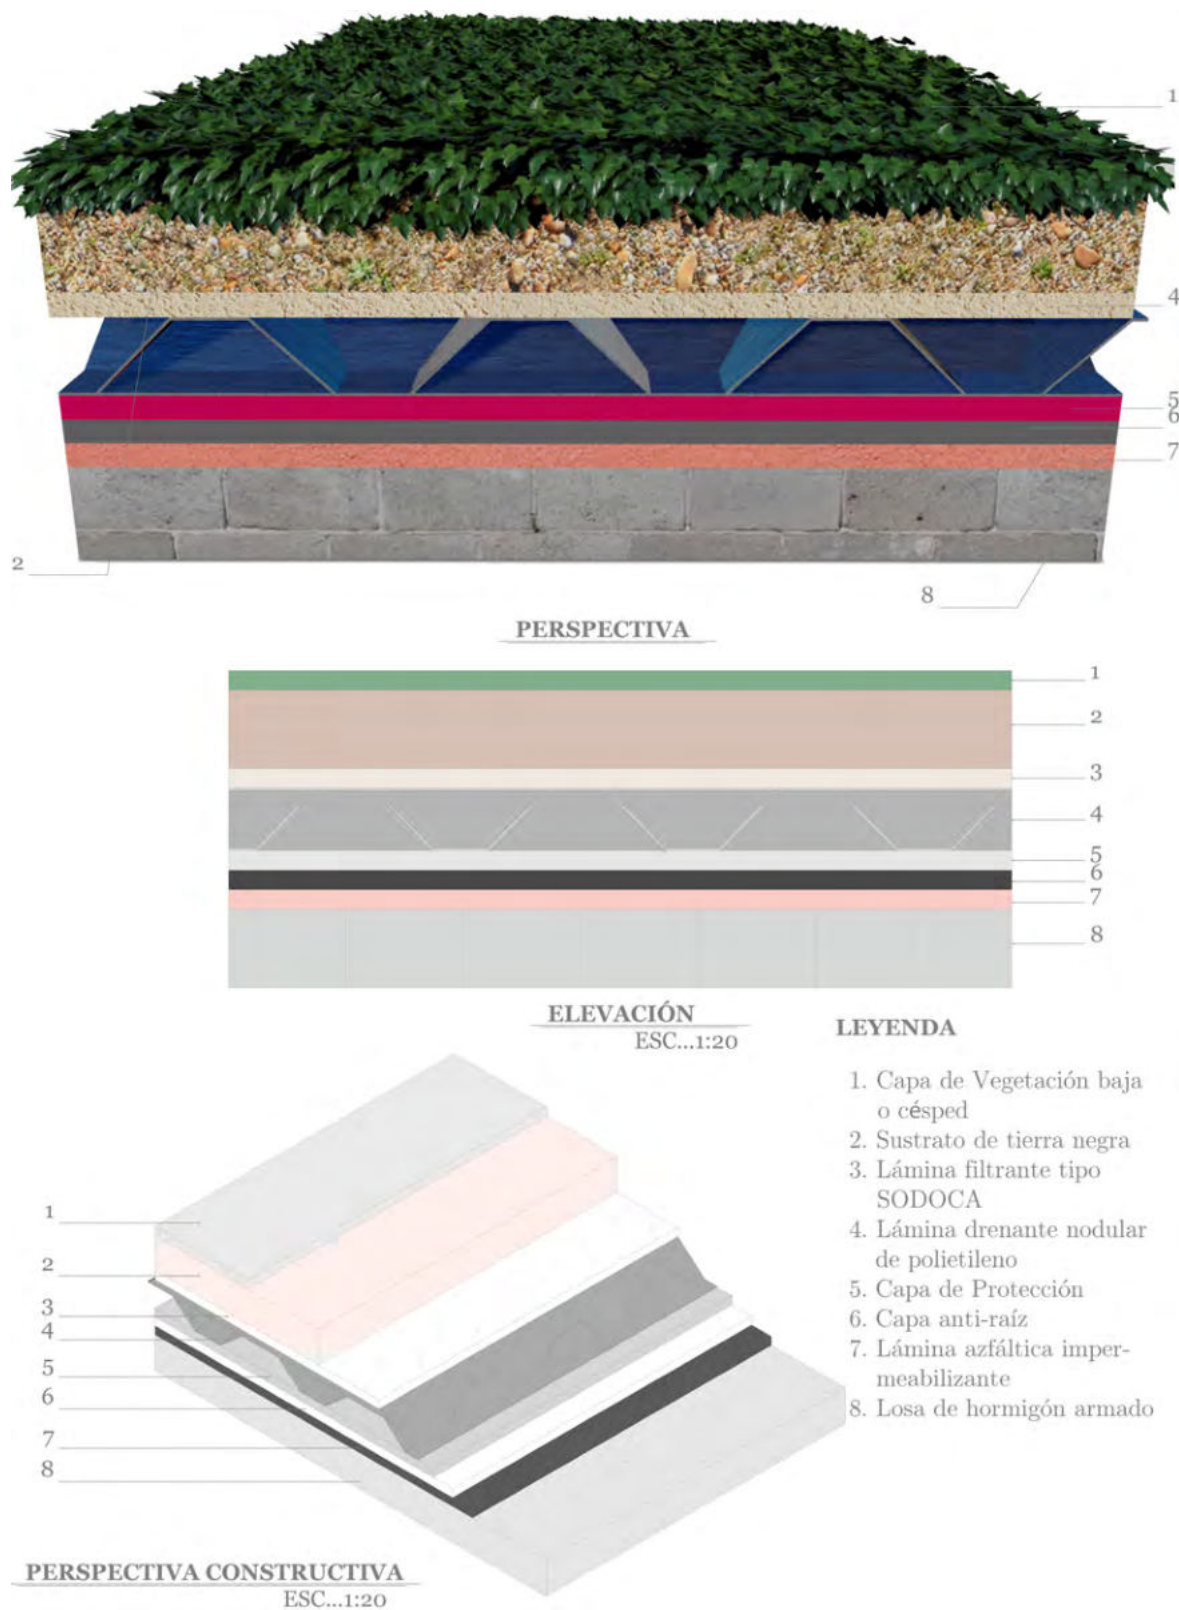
Detalle constructivo de un sistema de cubierta verde aplicada a una losa.
